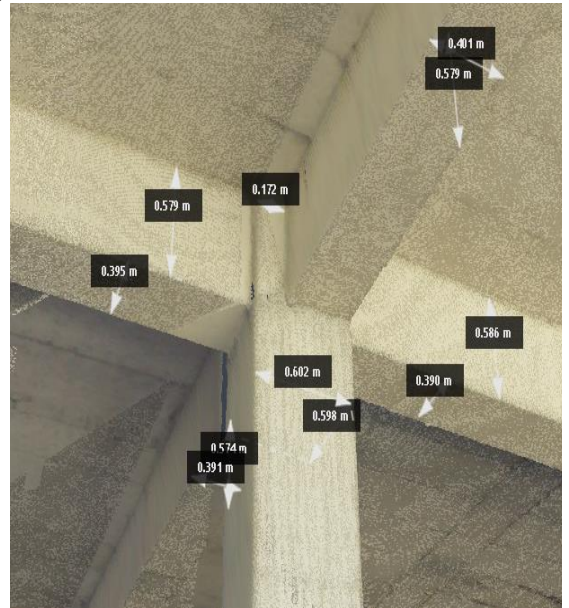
Mevcut Örnek Betonarme Yapının ReCap Modeli – Yapı Elemanlarının Detaylandırılması (Autodesk, ReCap 2026).
